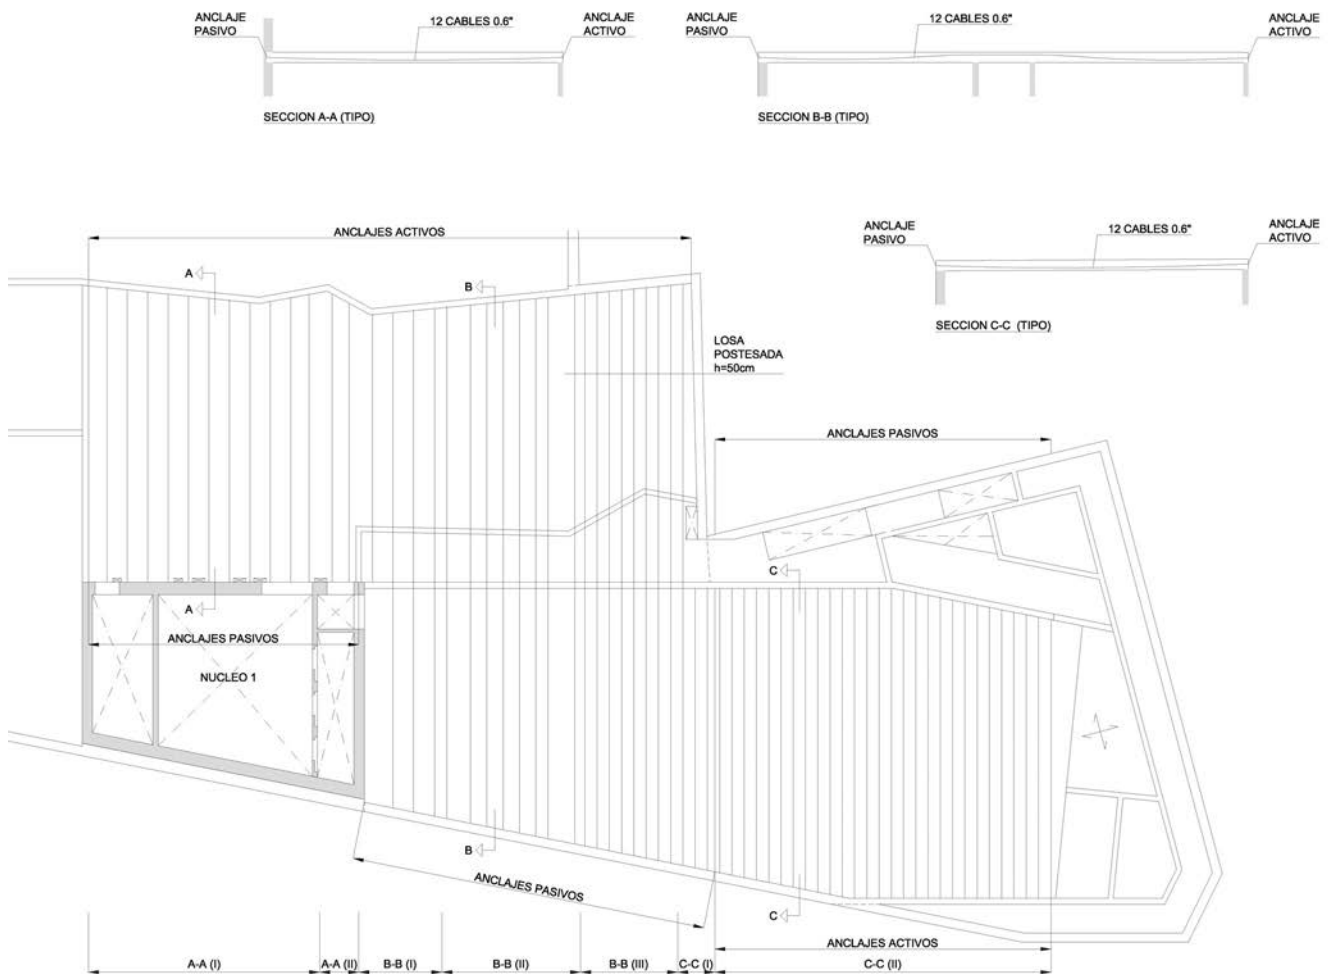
Losa postesada sobre auditorio. Planta y trazado de los cables.
